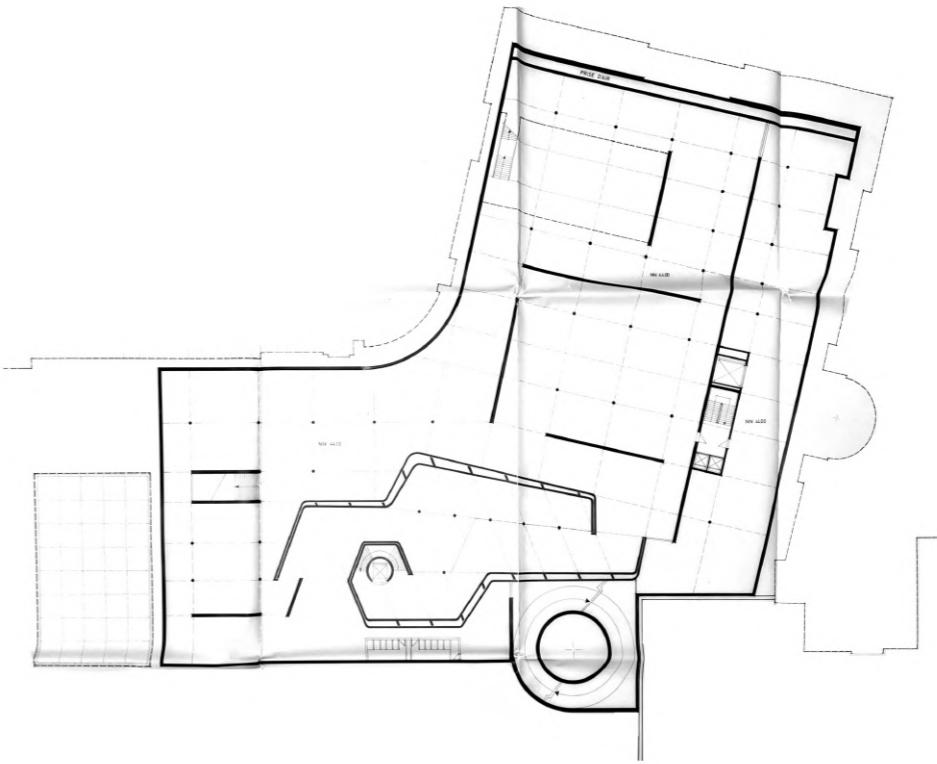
Plan R-3, 6^{ème} esquisse v3.
